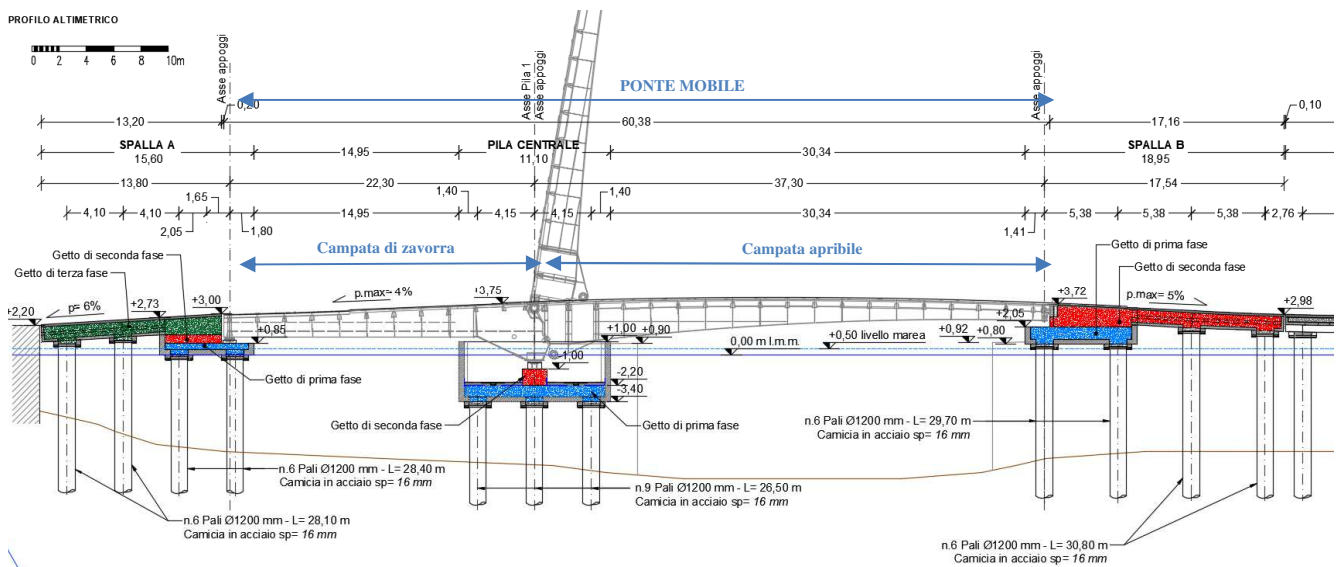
Profilo altimetrico della viabilità su pali (Spalla A, Pila Centrale, Spalla B)
